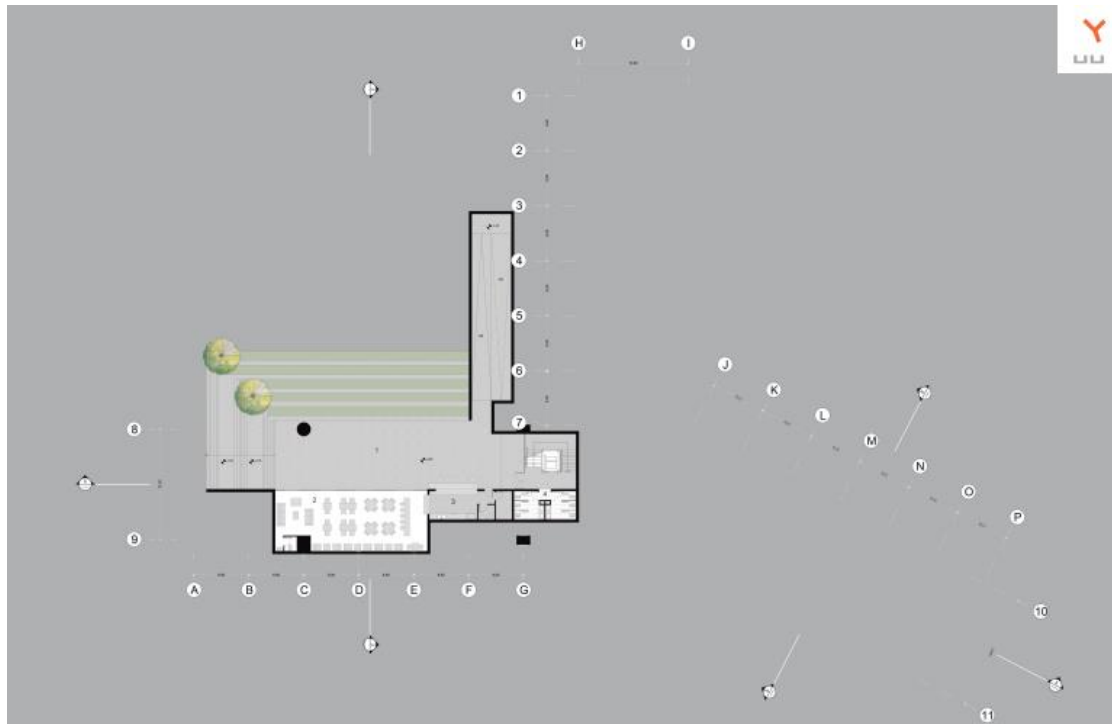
Planta nivel -3.24 Centro Comunitario (Fuente propia)
